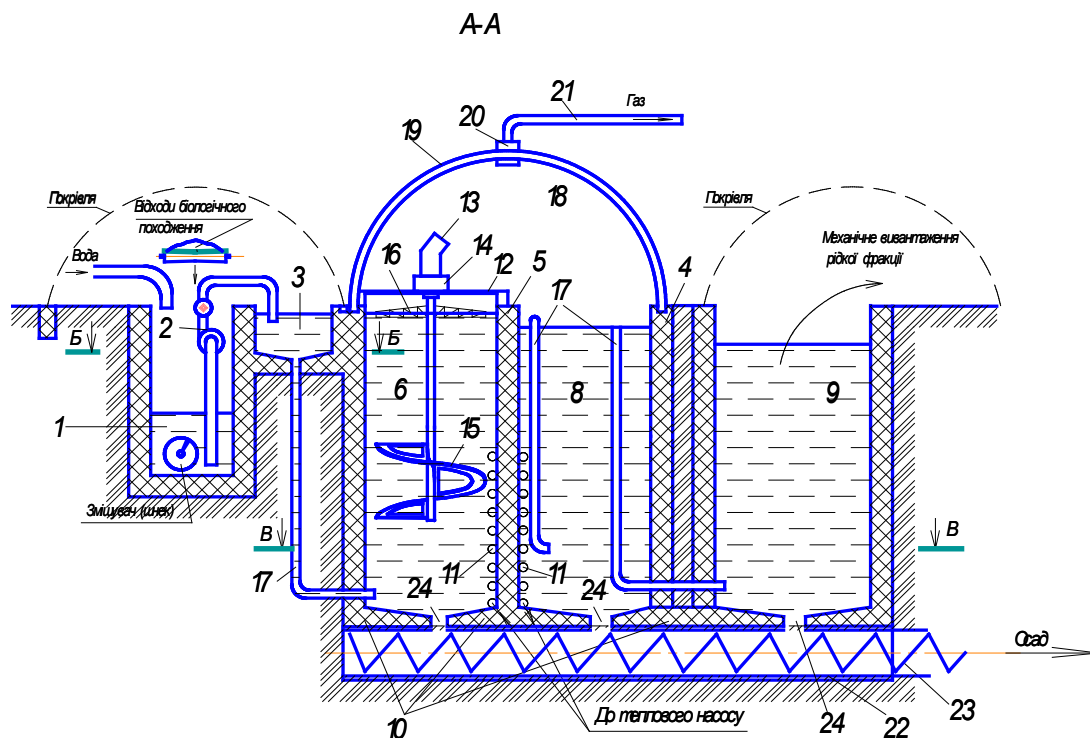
Розріз А-А біореактора з рис. 1 [5]
